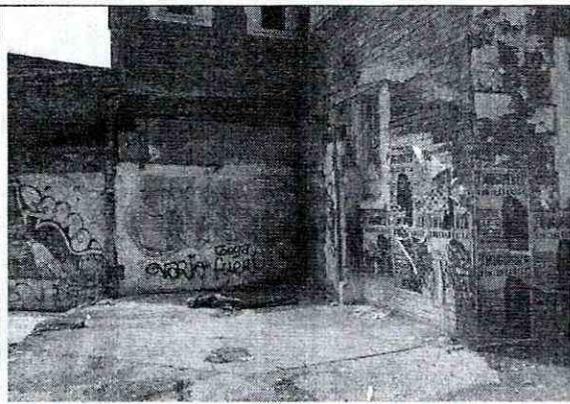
Muros perimetrales de la parte inferior en buenas condiciones.
